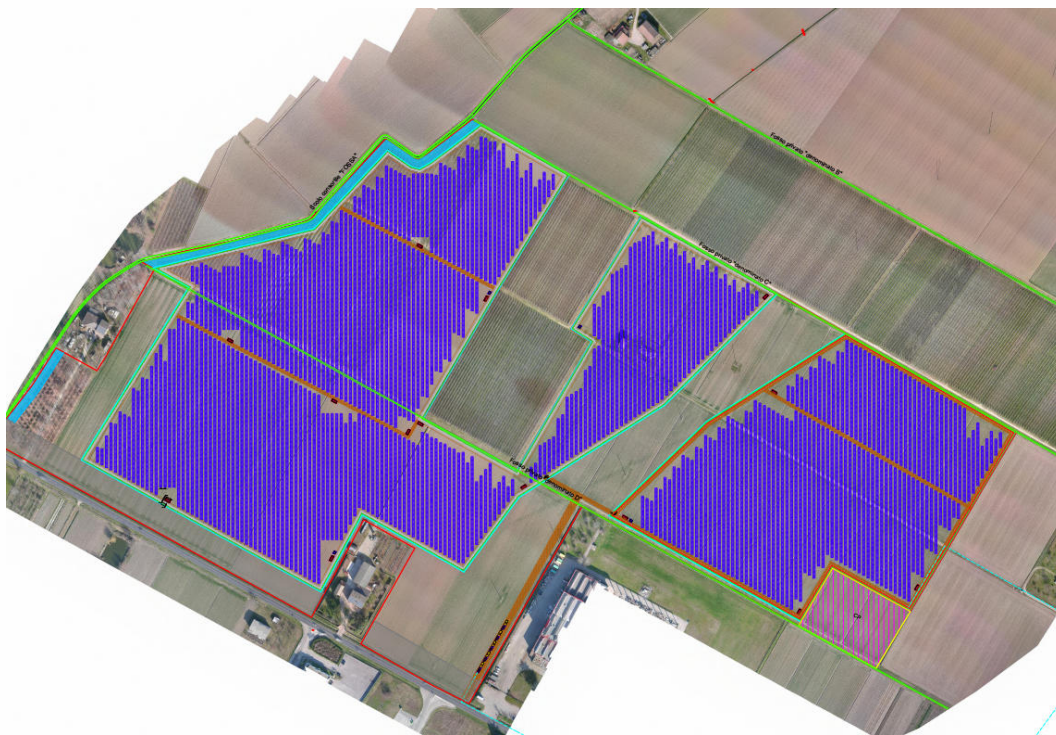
Planimetria di progetto. In rosso il perimetro dell'area di intervento, in blu le installazioni dei pannelli fotovoltaici, in verde le fasce di mitigazione, in marrone la viabilità permeabile interna.
